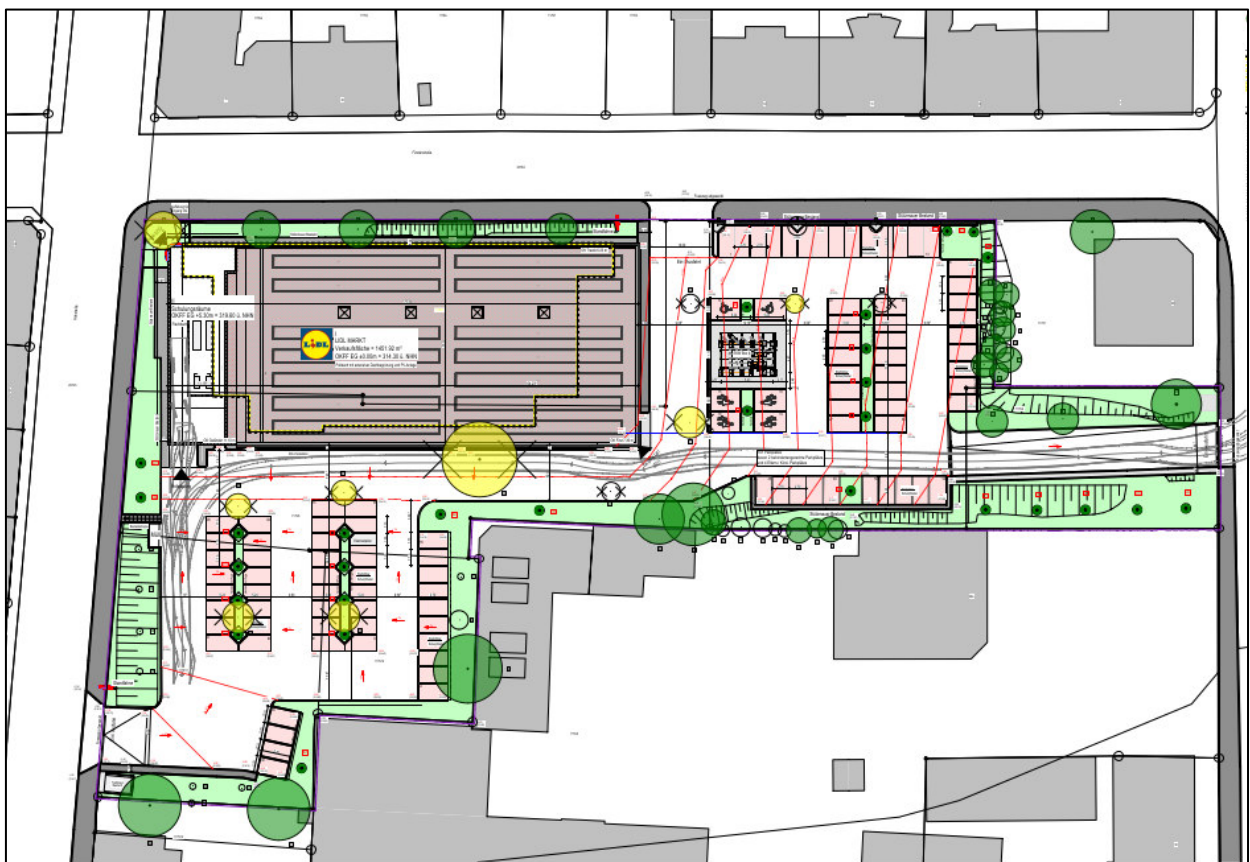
Lageplan Neubau Lidl-Markt Chemnitz, Fürstenstraße 5 (nicht genordet)
